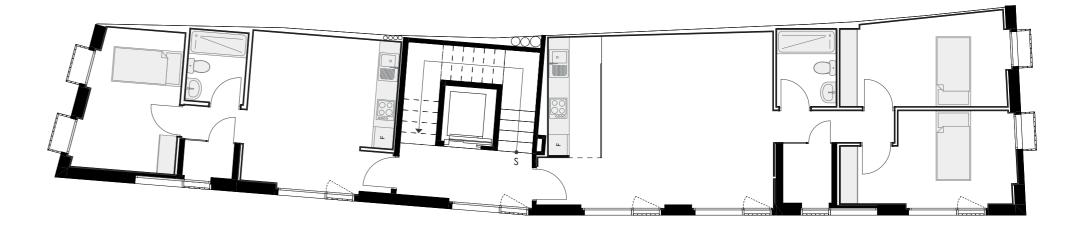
Planta baja, Vivienda para realojos en Pamplona Fuente: Autores, 2022 1m 2m 5m 10m
